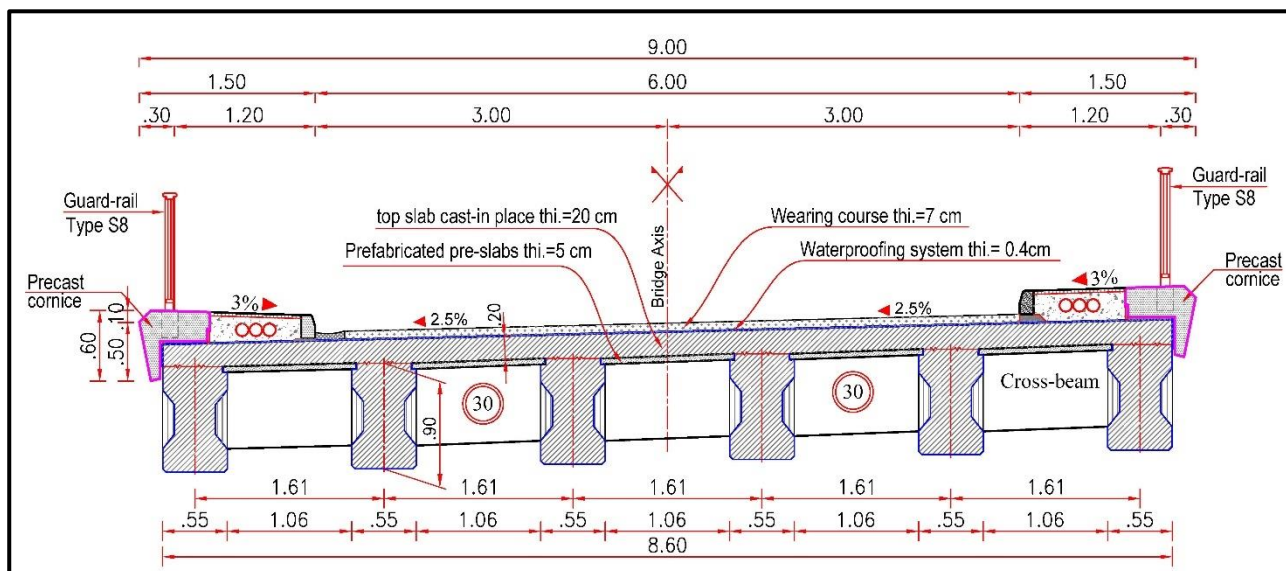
Secção transversal do tabuleiro - Ponte em viga de betão armado Brigoma
